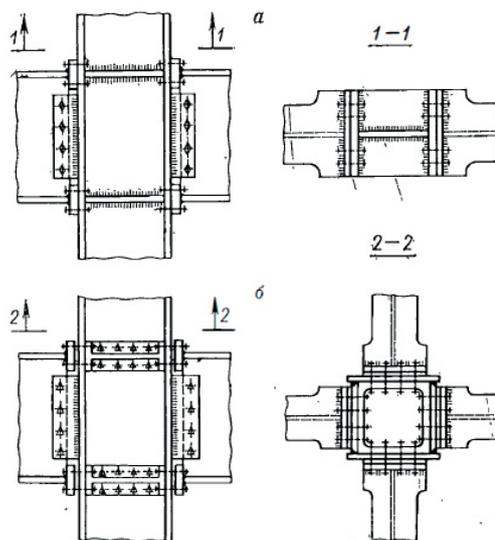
Болтовые узловые соединения ригелей с колоннами: а – двутаврового сечения; б – трубчатого сечения
